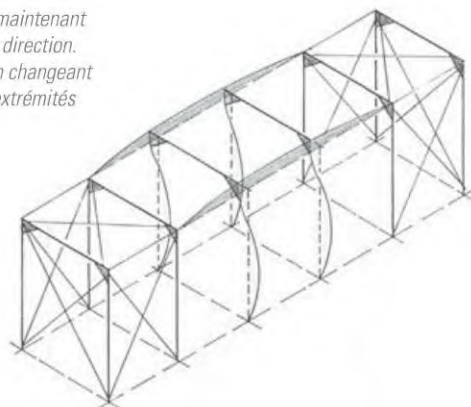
Application avec six portiques alignés, poutres encastrées sur les poteaux et poteaux articulés en pieds.
